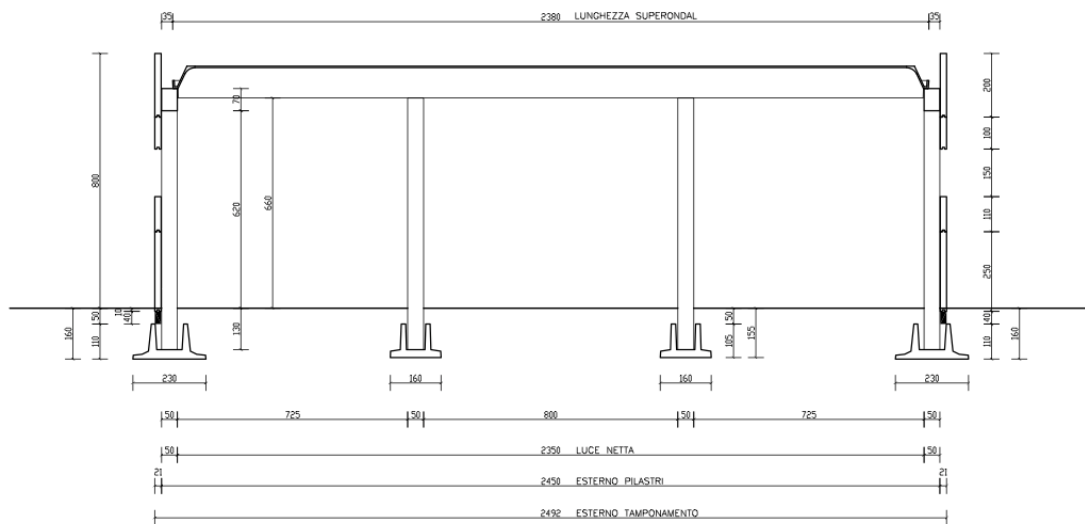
Sistema di fondazioni isolate per edifici industriali
